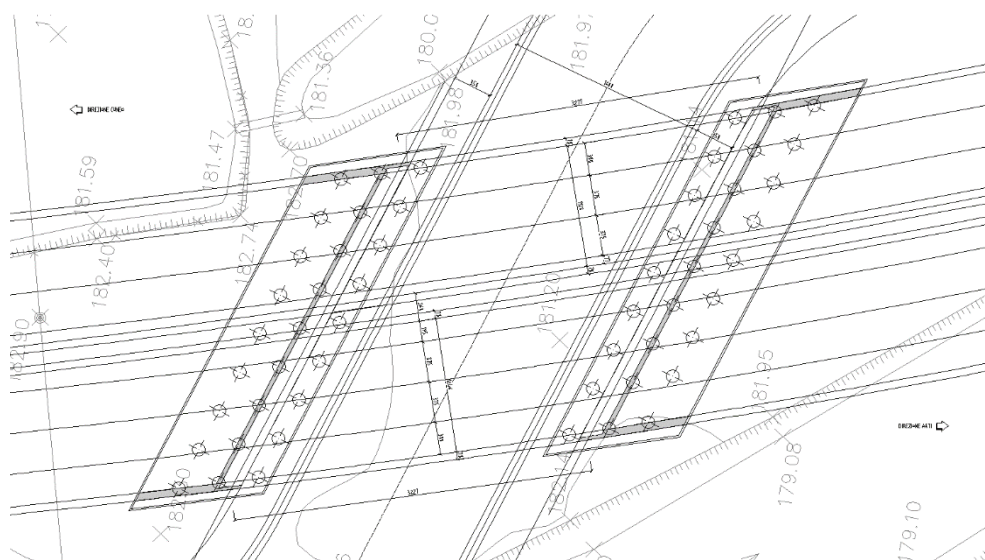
Attraversamento Canale ENEL: vista planimetrica
